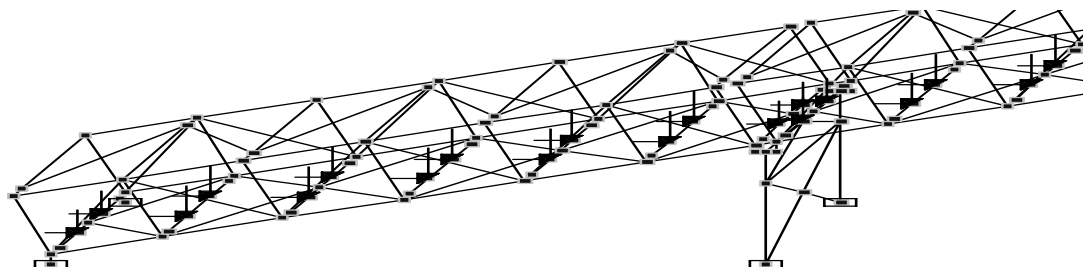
Основные конструктивные части решётчатой конвейерной галереи: 1 — пролётное строение, 2 — ветровая рама, 3 — плоская (шарнирная) опора, 4 — неподвижная (анкерная) опора, 5 — опорное закрепление.
